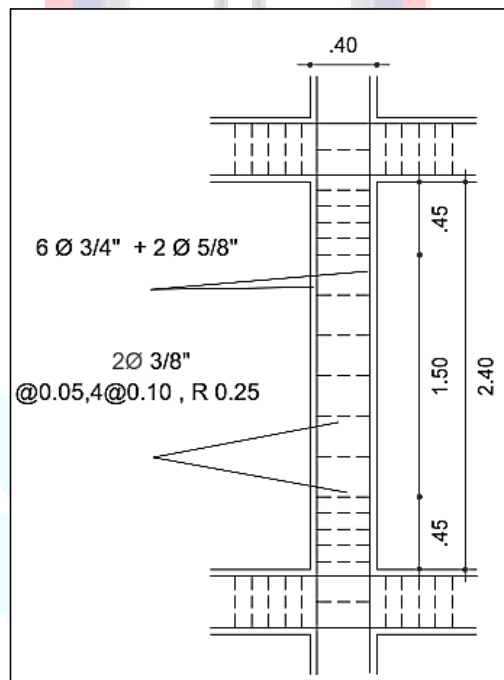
Detalle del refuerzo corte y elevación en columnas
